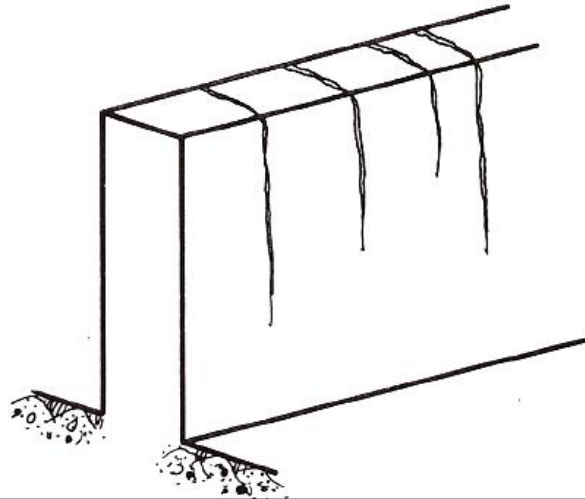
Fisuras de retracción hidráulica en muros de hormigón.
